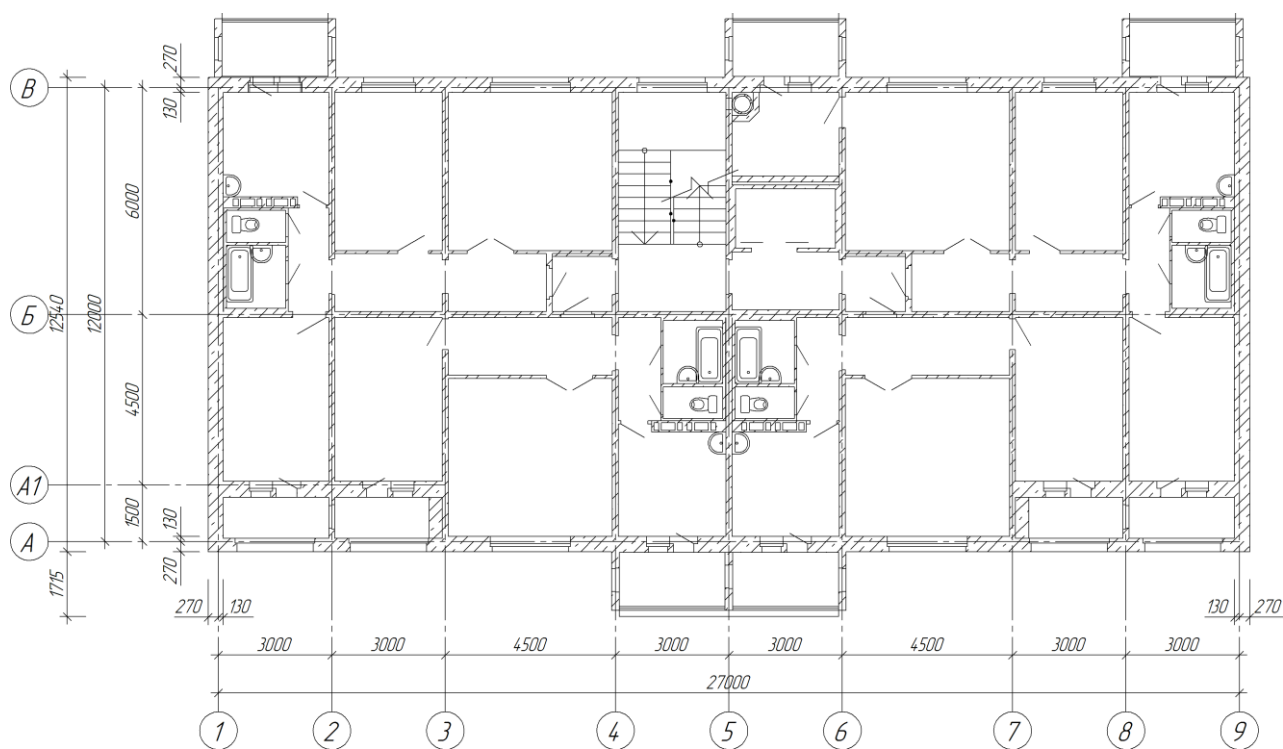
План типового этажа: 97с КОПЭ-9 улучшенная
